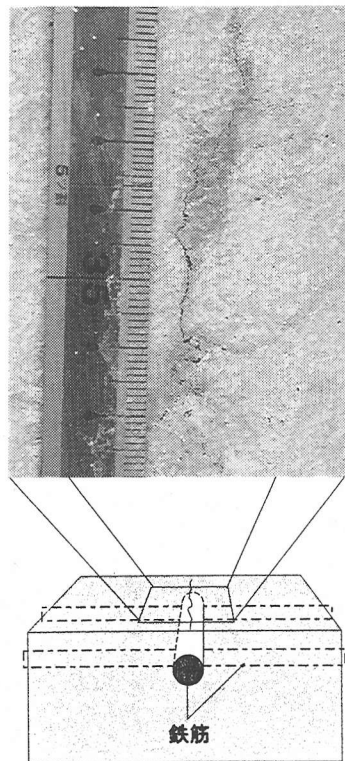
RCはりの打込み面に発生した沈下ひび割れ
